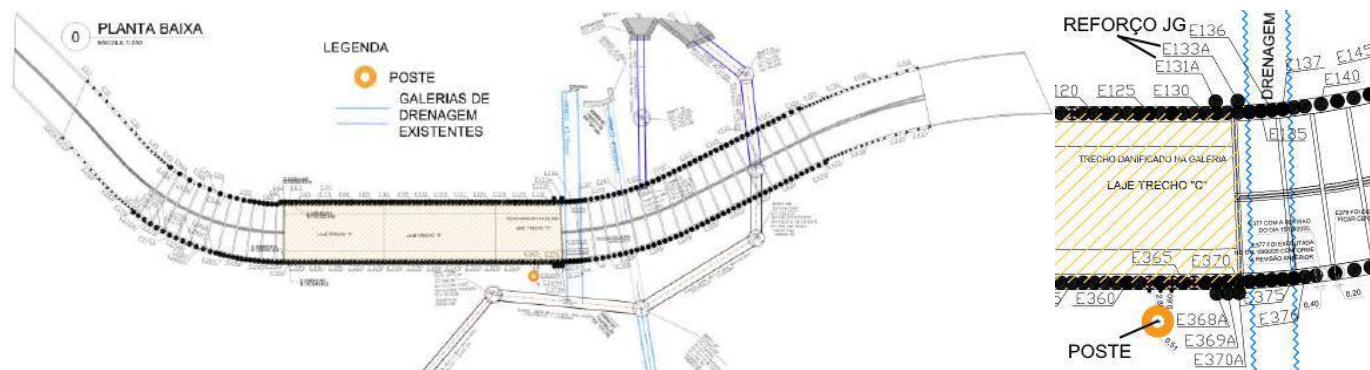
Planta com interferências cadastradas e detalhe dos reforços executados nas proximidades da galeria
